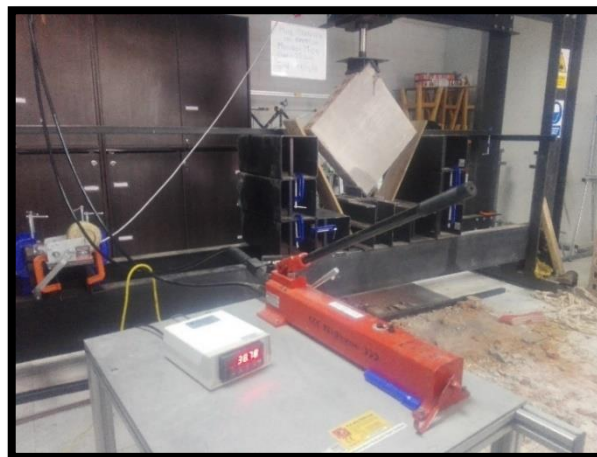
Colocación del muro ladrillo pandereta a máquina de compresión diagonal
